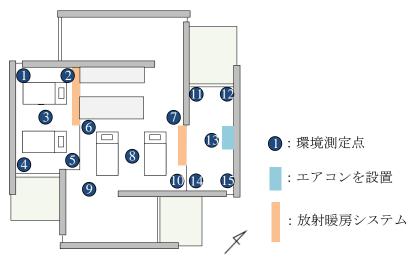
慶應型共進化住宅の平面図及び環境測定点の位置
